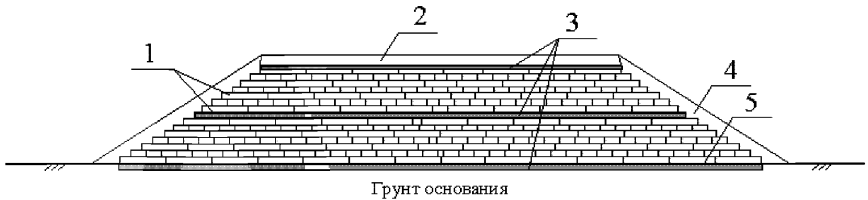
б - Конструктивная схема НППБ трапецеидальной формы с прослойками из пенобетона: 1 – ППБ, 2 – дорожная одежда, 3 – пенобетон, 4 – грунтовое покрытие откосов, 5 – выравнивающий слой песка
